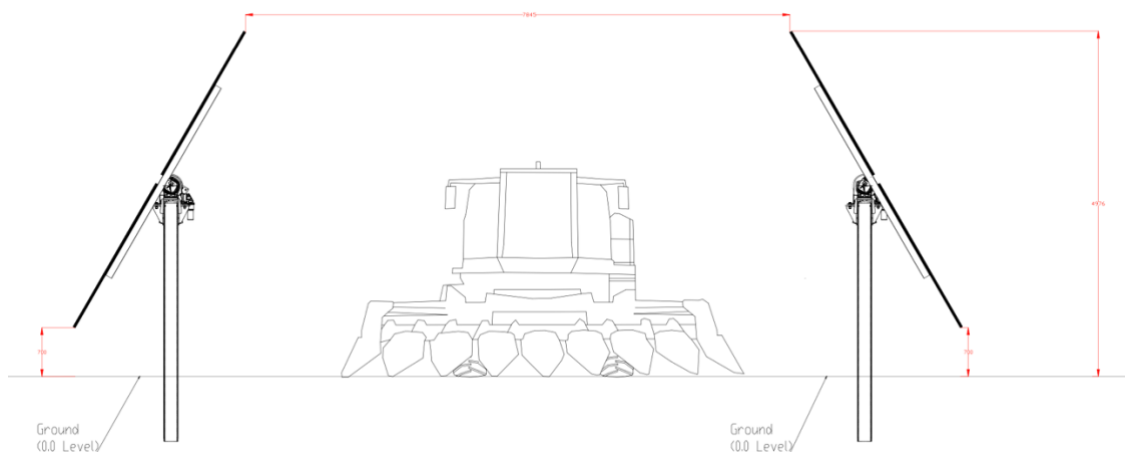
Particolare delle lavorazioni su file alternate (planimetria).
